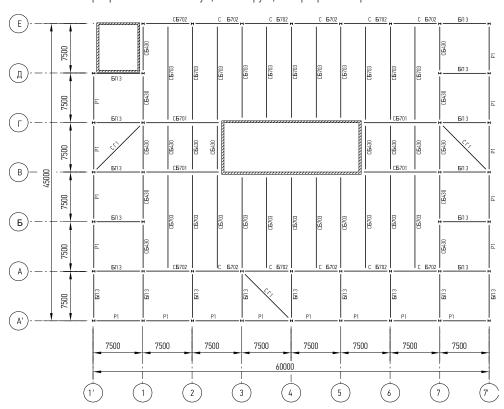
Вариант каркаса с применением стальных конструкций при сетке 7,5х15 м. Маркировочный план несущих конструкций перекрытия второго этажа
